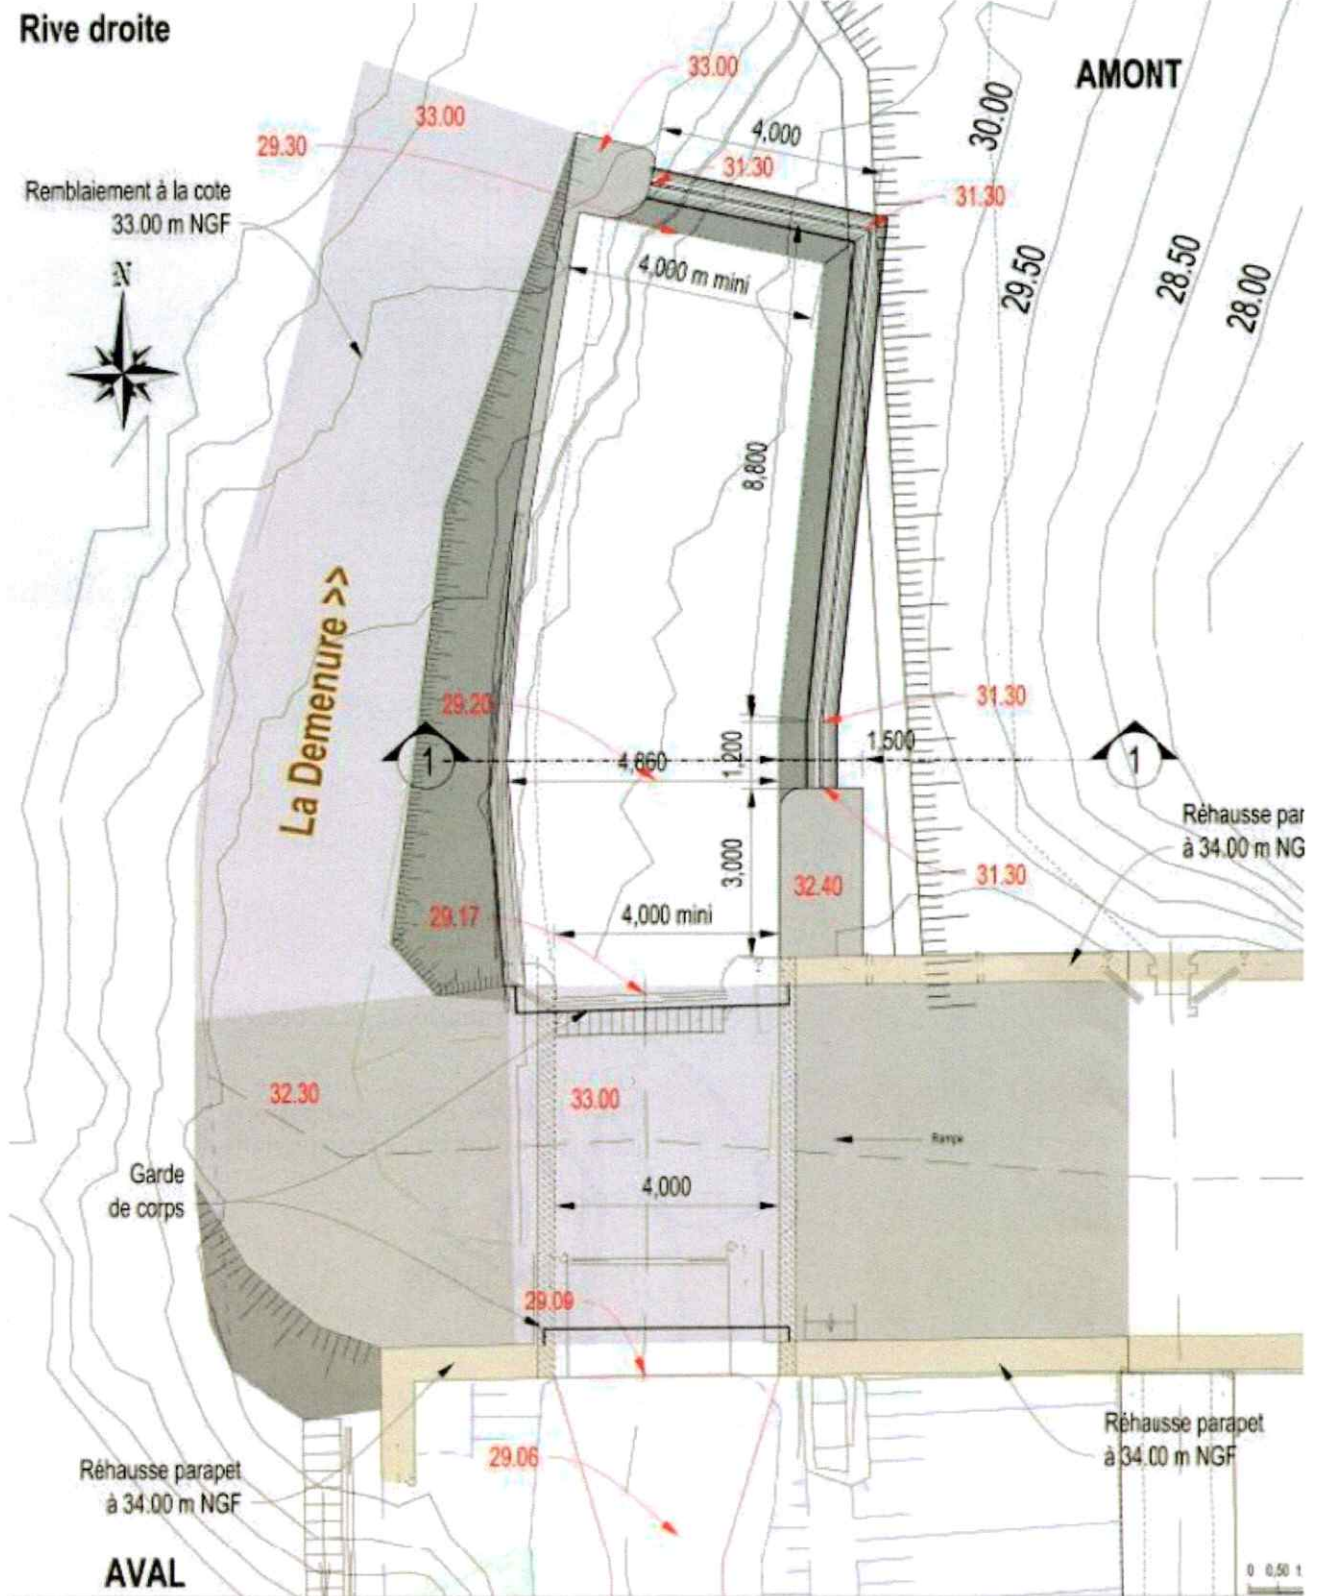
Extrait de la vue en plan (source études AVP ISL)
